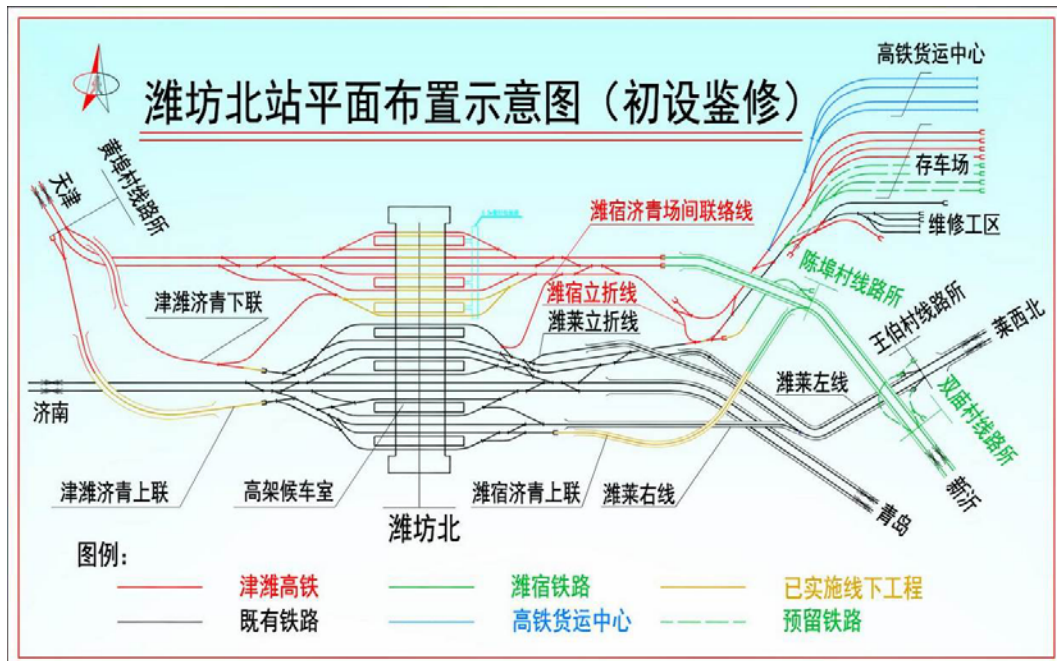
潍坊枢纽相关工程平面布置示意图
